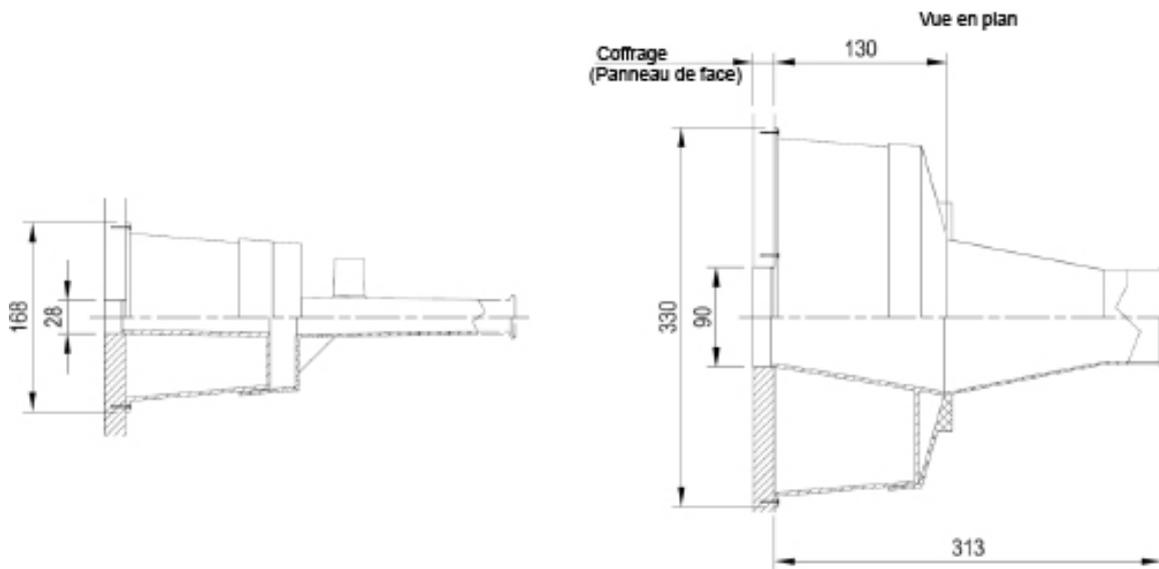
Ancrages type S 6-4 – Dimensions dispositif d’installation
